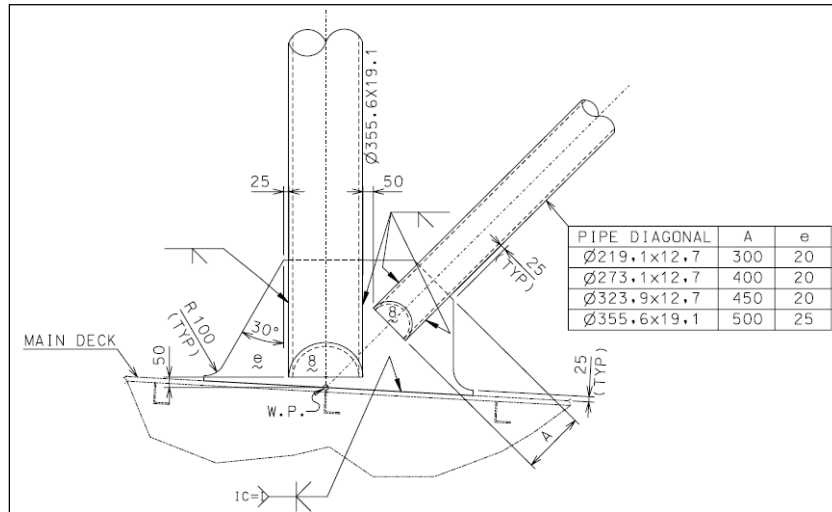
Suporte do módulo – conexão tipo 2 – vista transversal.
